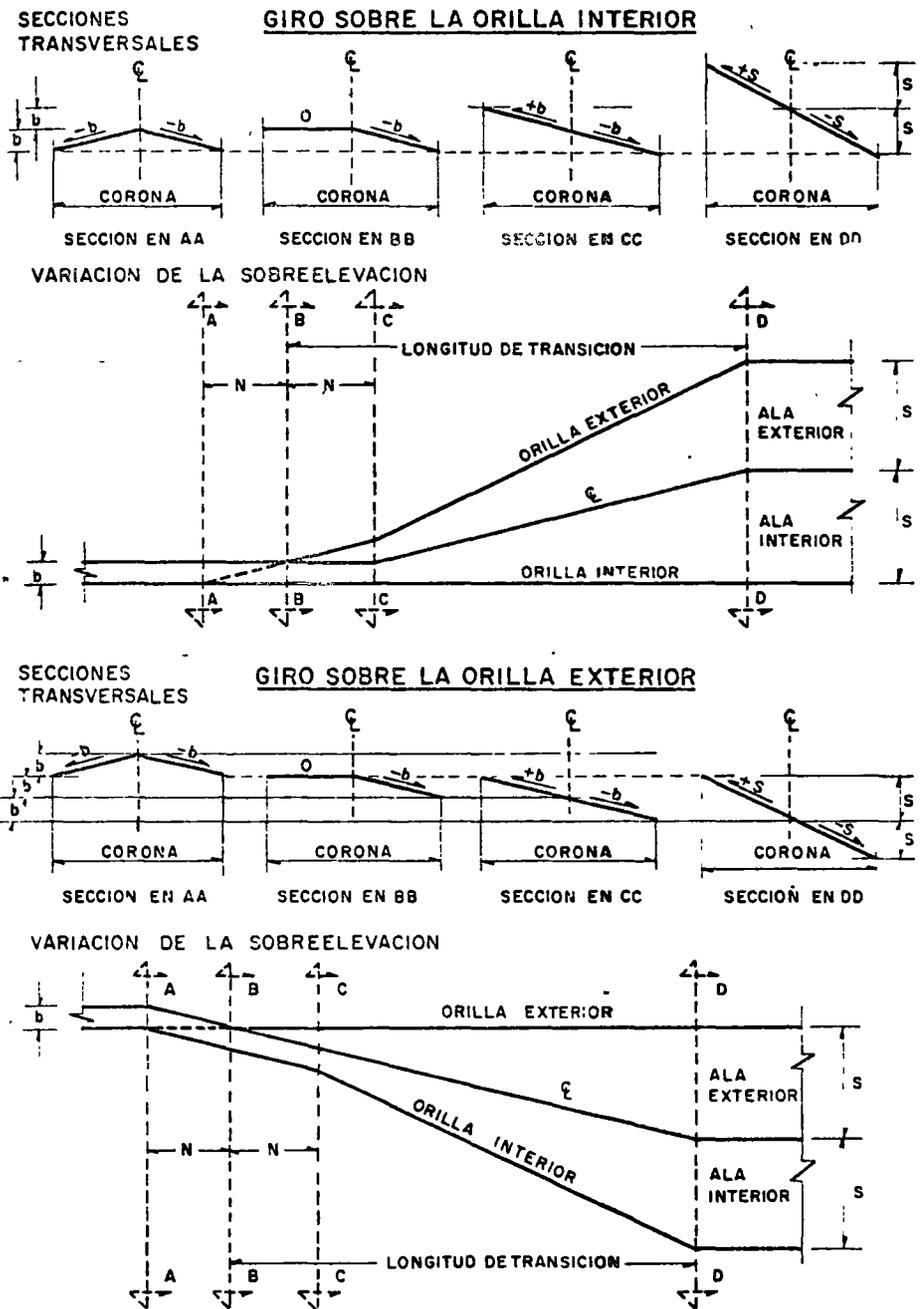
TRANSICION DE LA SECCION EN TANGENTE A LA SECCION EN CURVA GIRANDO SOBRE UNA ORILLA DE LA CORONA
